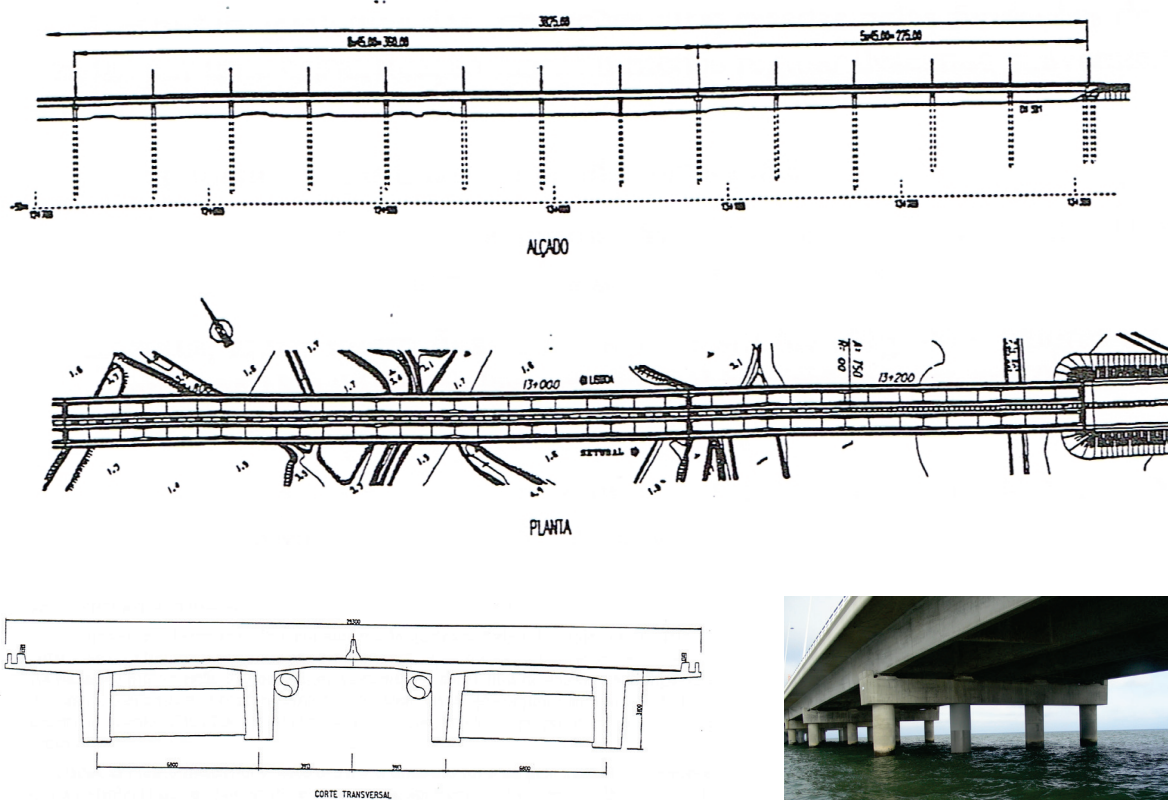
Planta, perfil longitudinal dum módulo e secção transversal
